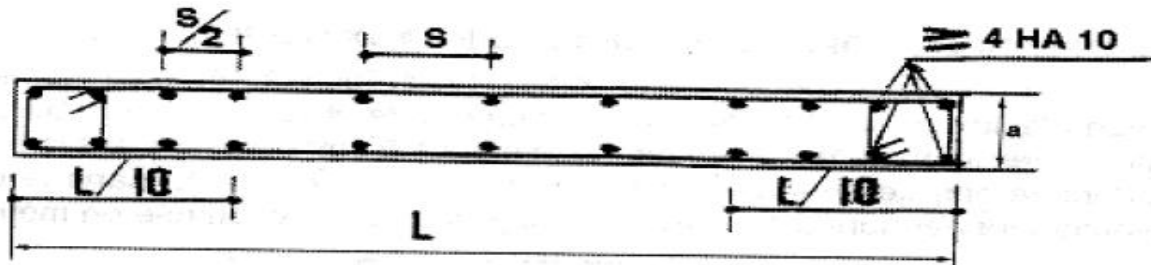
Disposition du ferrailage dans un voile plein classique.
